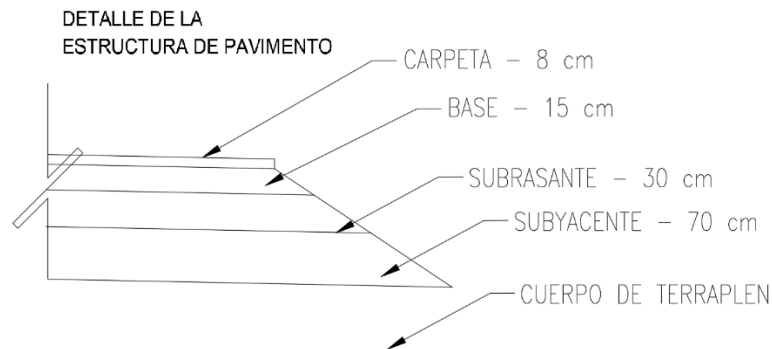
Sección tipo y detalle de la estructura del pavimento sin escala
